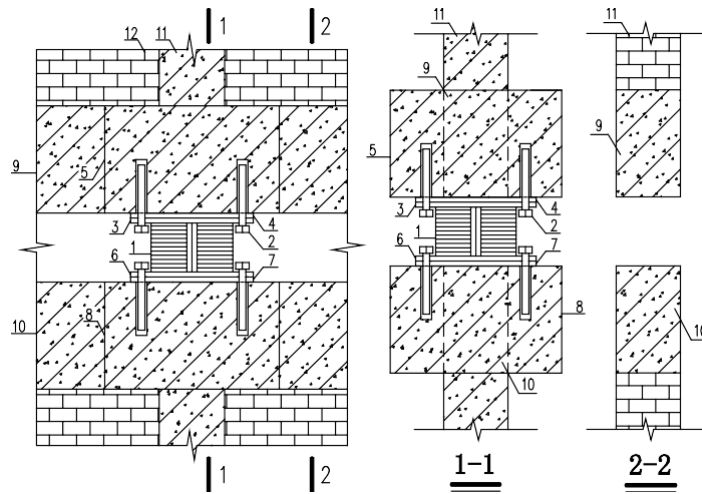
单梁构造柱下隔震支座安装示意图
